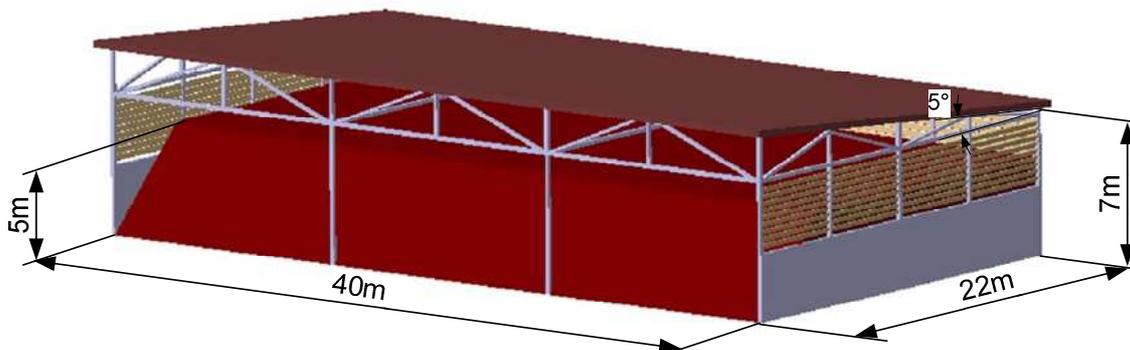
Skizze Lagerhalle in Flugdachausführung
